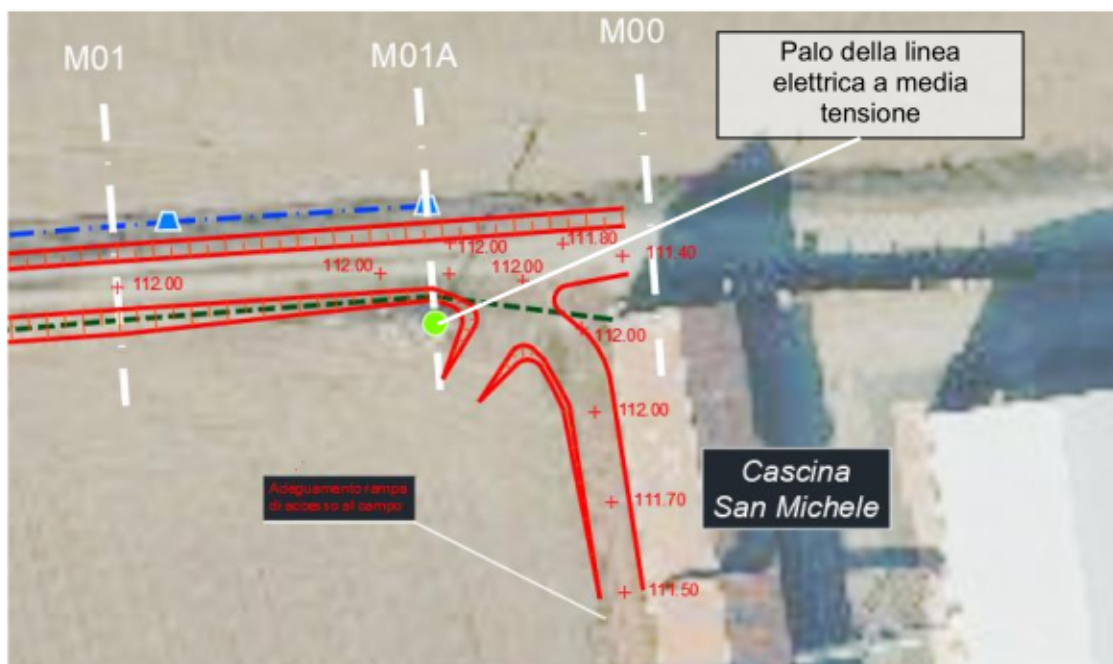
ESTRATTO DELLA PLANIMETRIA DI PROGETTO DELL'INTERVENTO N°2 IN CORRISPONDENZA DELLA SEZIONE M01A
